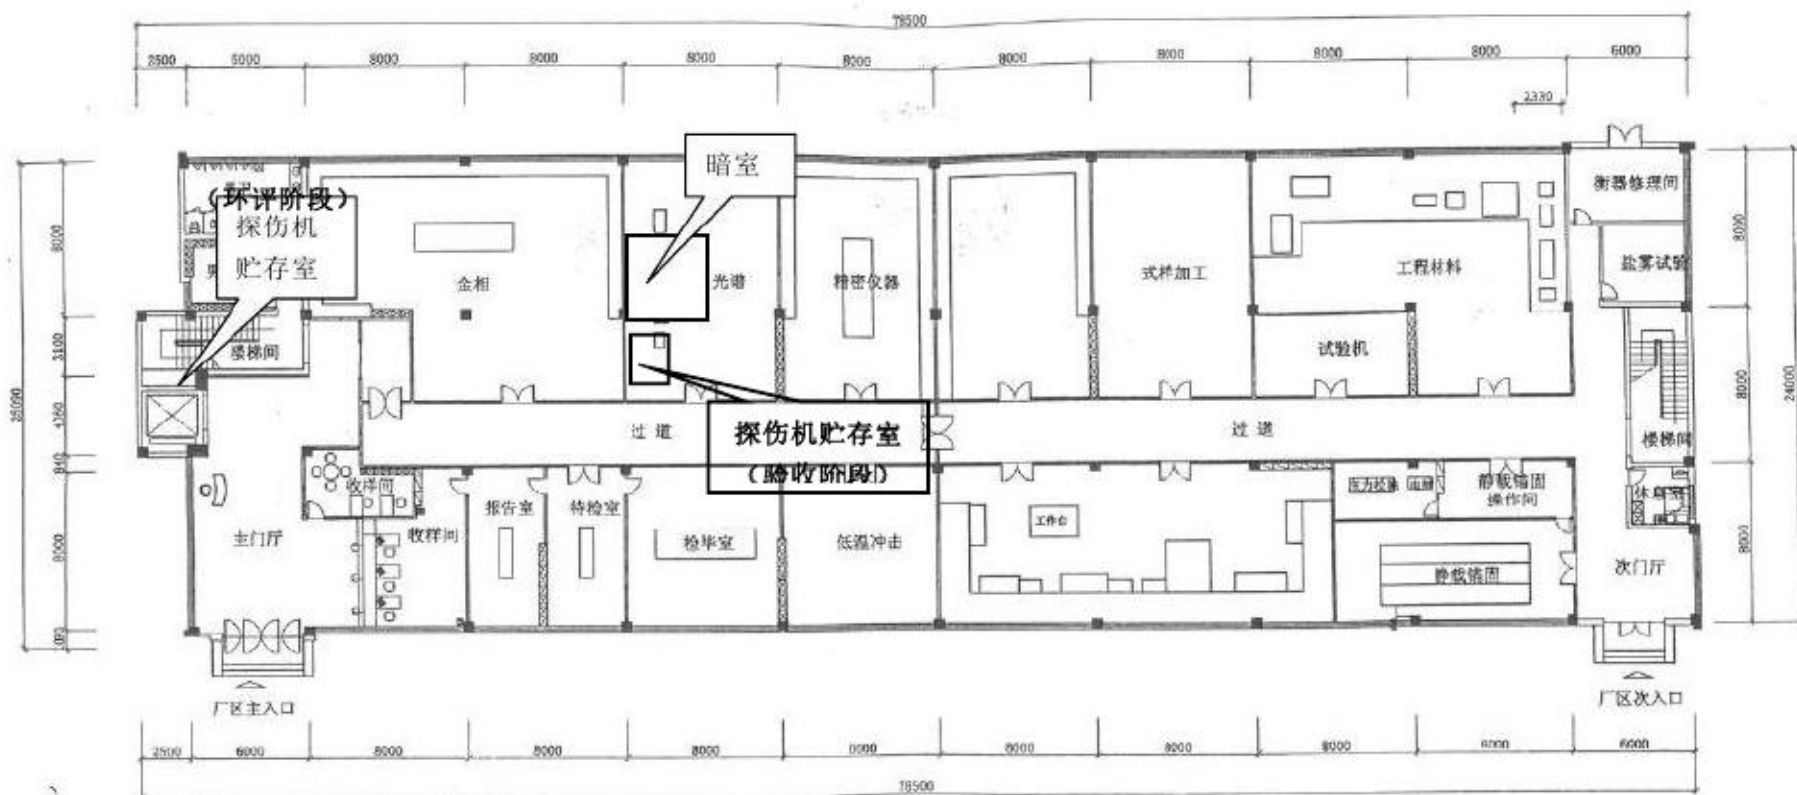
一楼总平面布置图（探伤机贮存场所、暗室）
